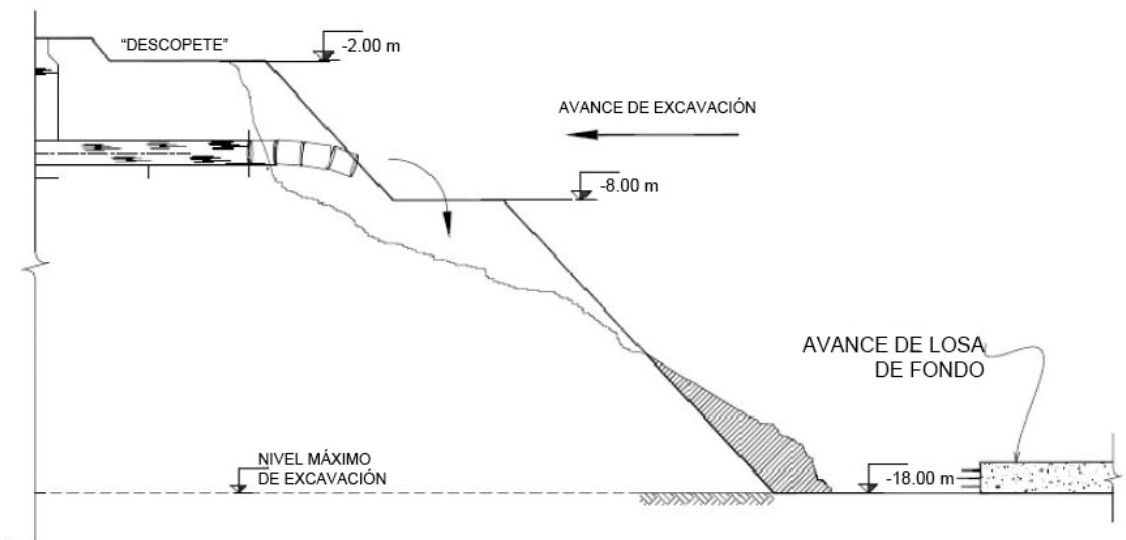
Falla del talud durante la construcción de la Estación Centro Médico L-9.
